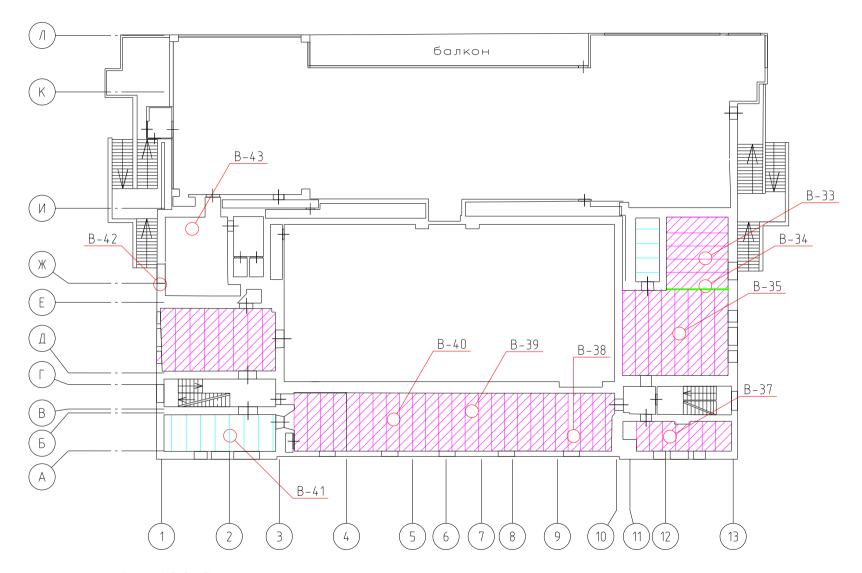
Схема участков вскрытий над вторым этажом с раскладкой плит и балок.
